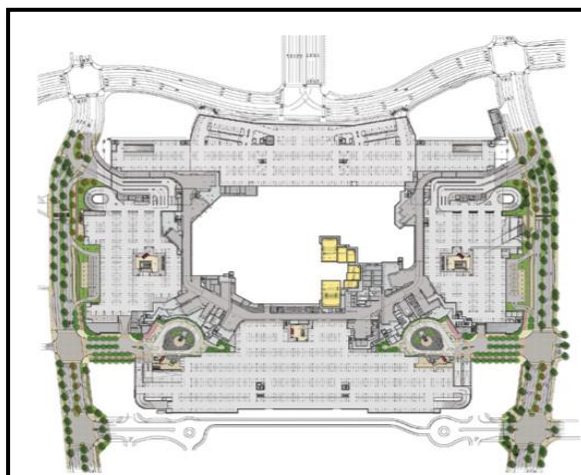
Plan 2<sup>ème</sup> étage : livraison de tunnel de camion et parking
